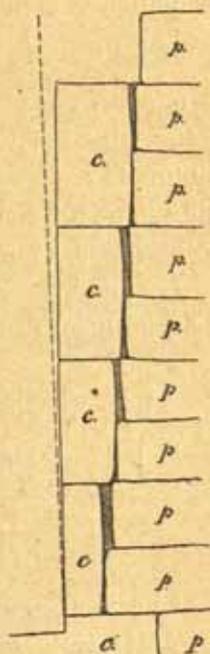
Coupe du revêtement en pierre de Tourah d'une muraille en calcaire du pays.
